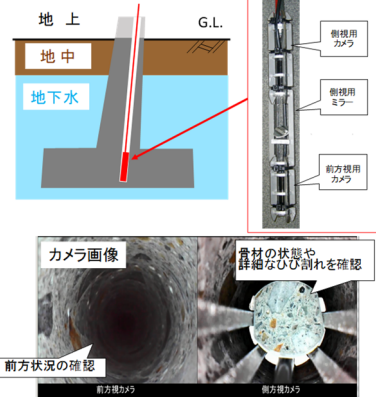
基礎コンクリート深部のひび割れ診断技術
